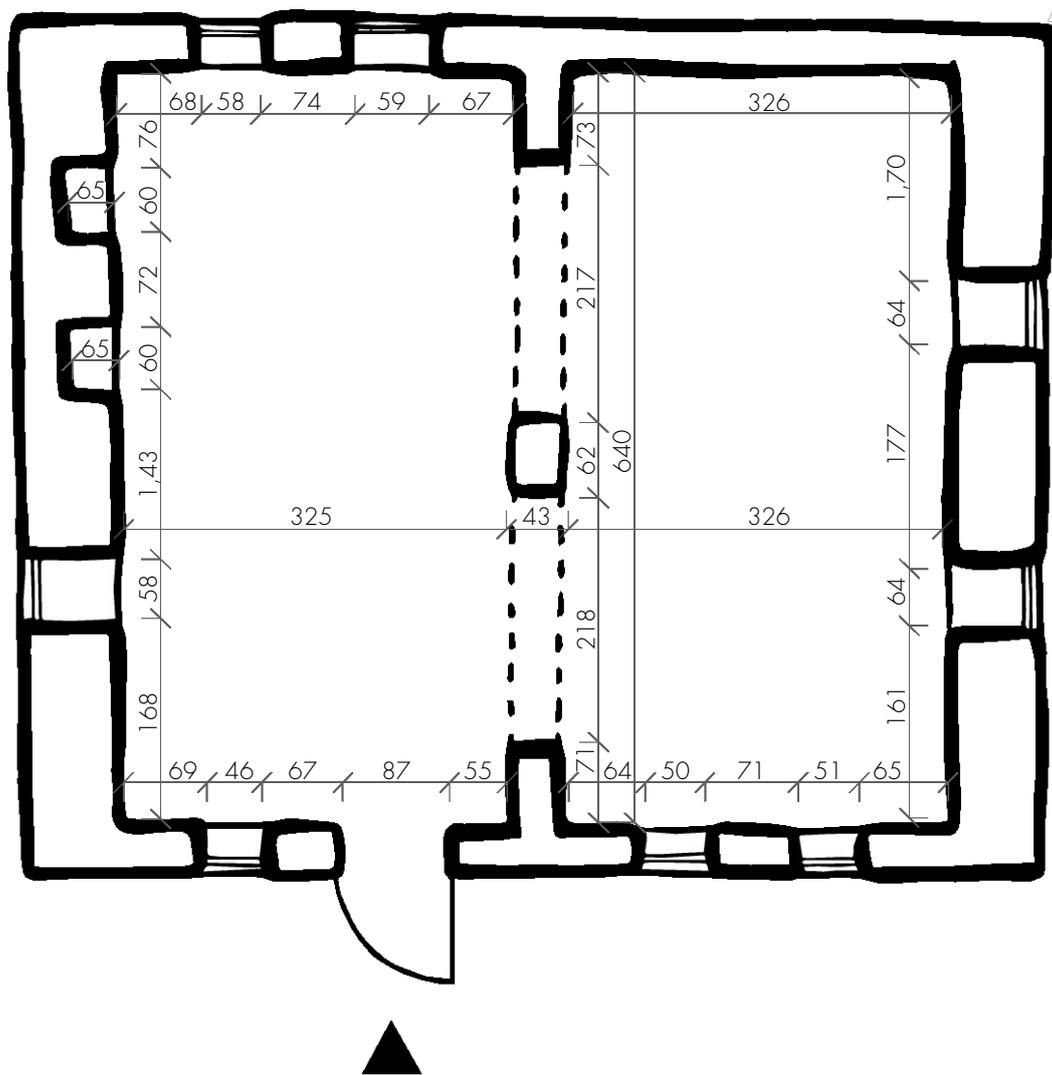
| Grundriss vom AVN Office Garu
